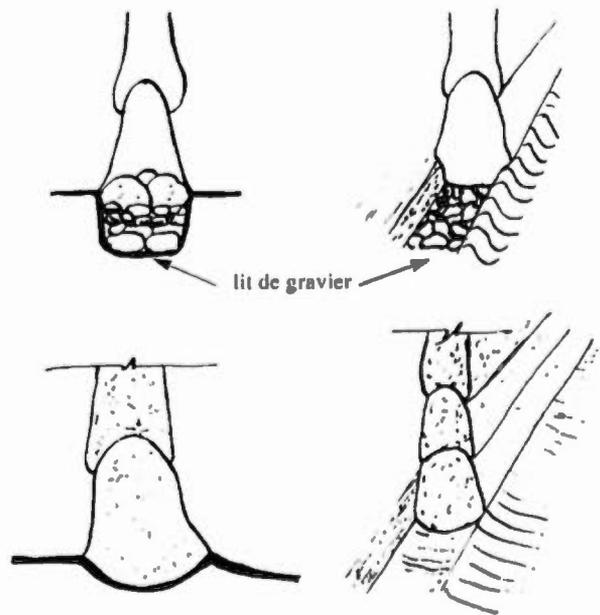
Schéma des fondations réalisées pour les murs en terre façonnée (Kéré, 1995, p.16)
